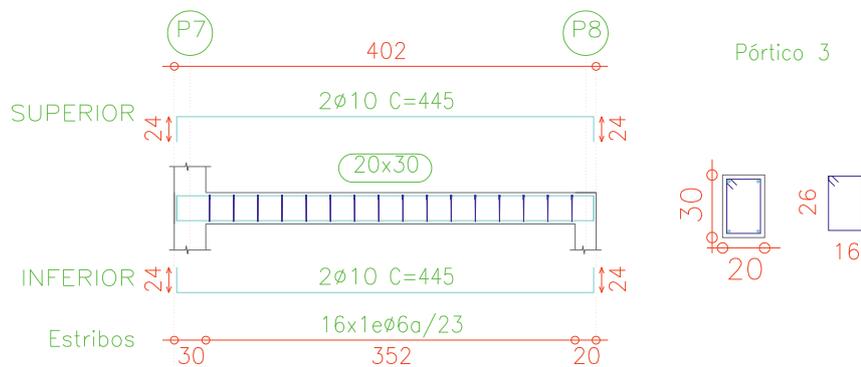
Pormenor do pórtico 3 de viga em BA
